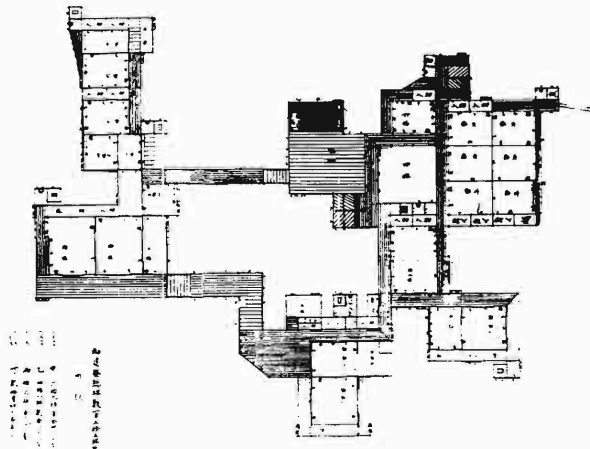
北白川宮葉山別邸 (B 棟) 平面図
